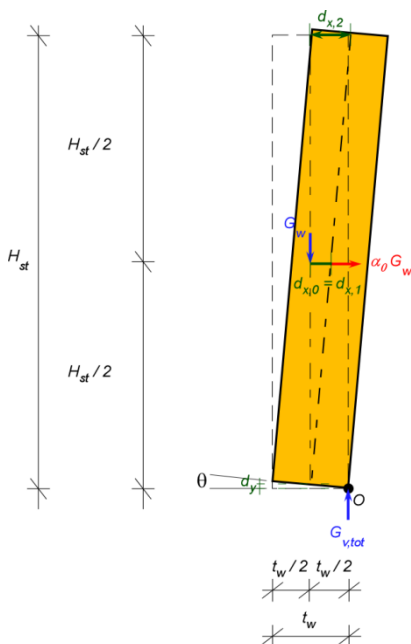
Notations et système statique avec la rotule dans la zone de compression au bord extérieur du pied du mur.
